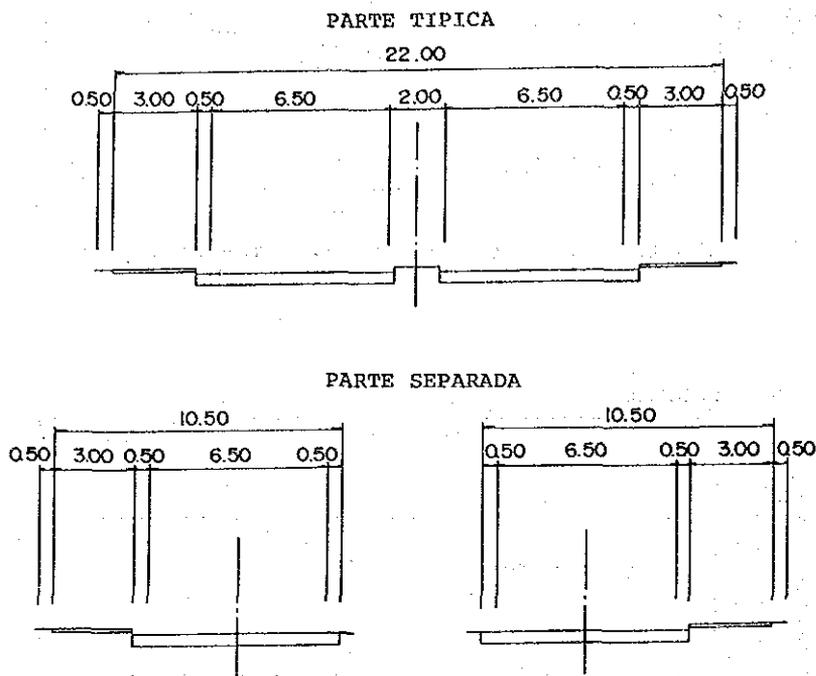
SECCION TRANSVERSAL (4 CARRILES)
